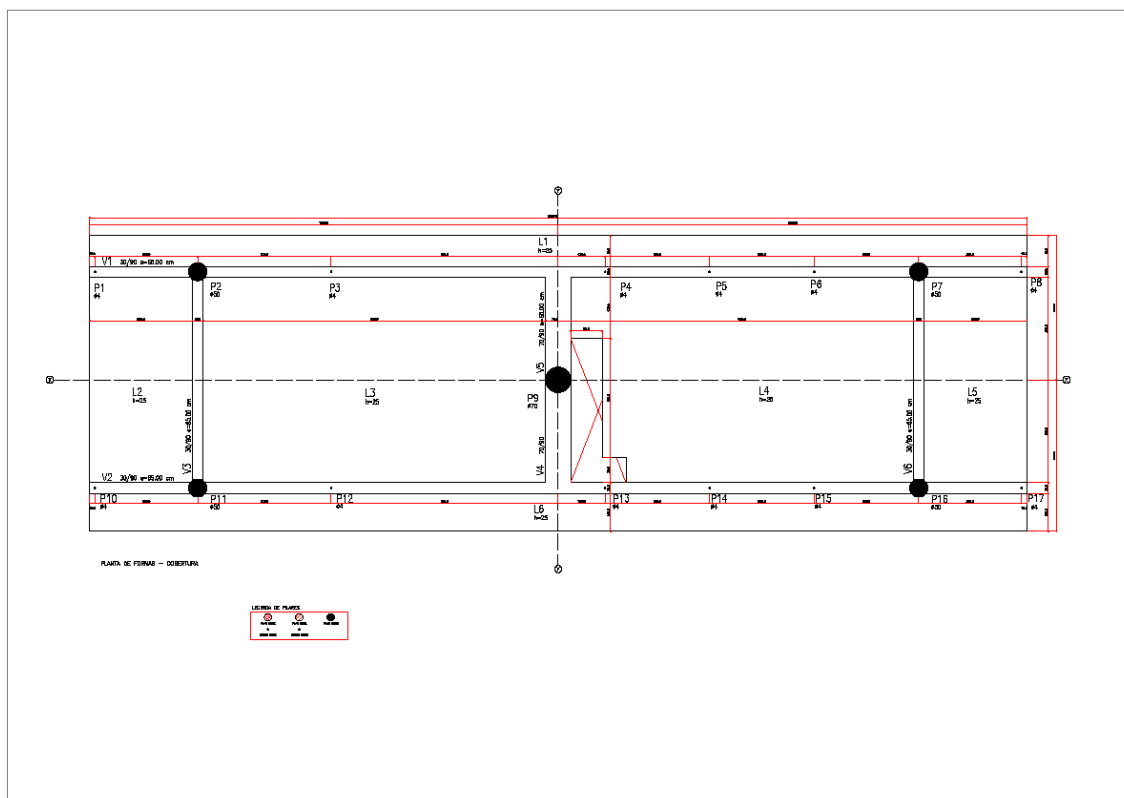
Cobertura: planta de formas. Fonte: AUTOR (2017).
